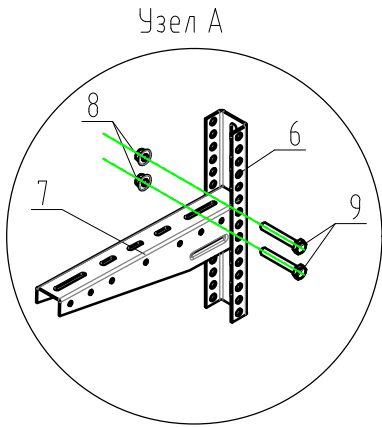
Вариант крепления траверсы на шпильках к бетонному перекрытию
